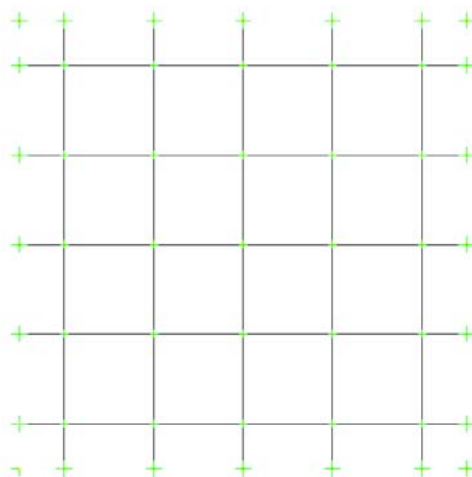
Laje discretizada com grelha de 80x80 cm
